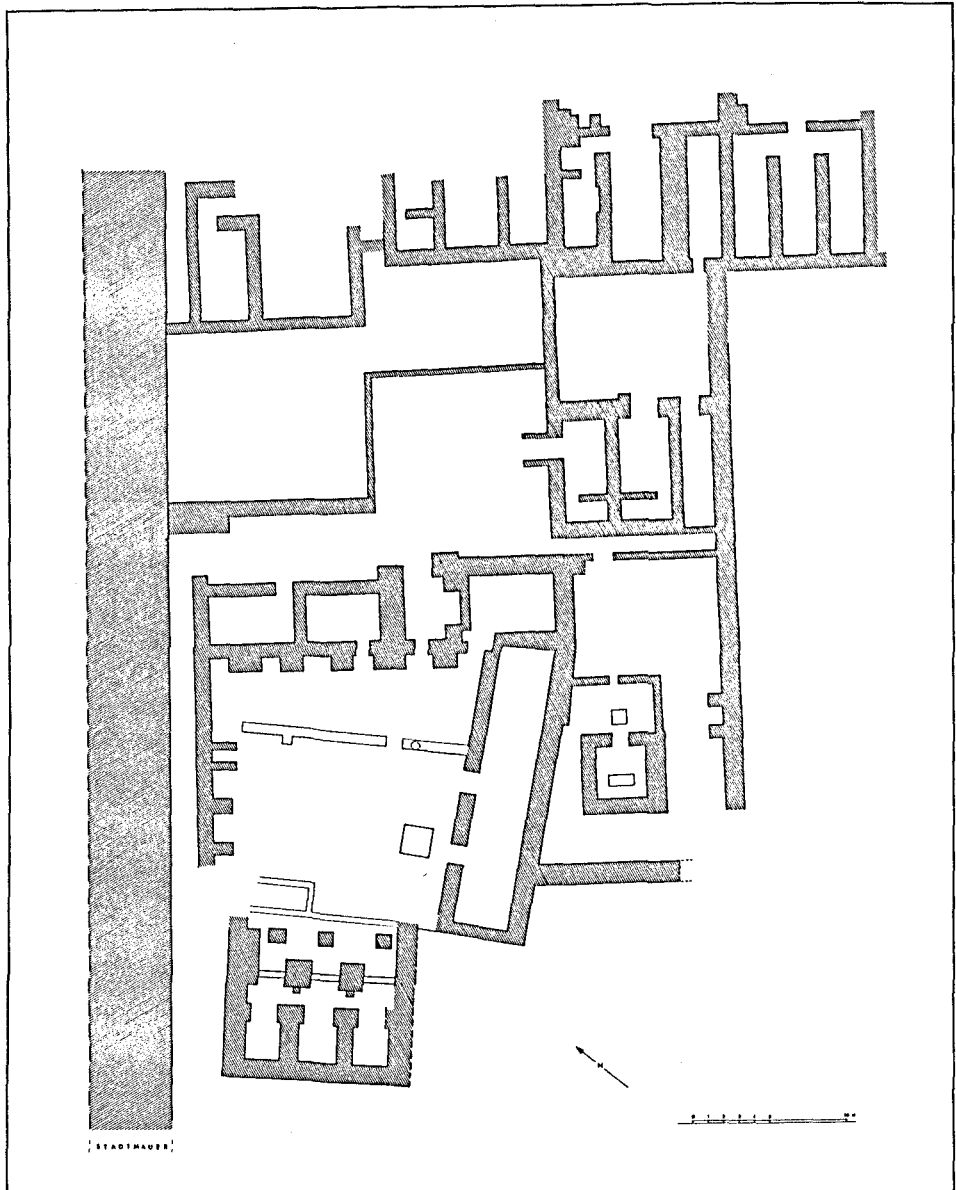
Ruqbat al-Madā'in. Grundrisse an der Stadtmauer
